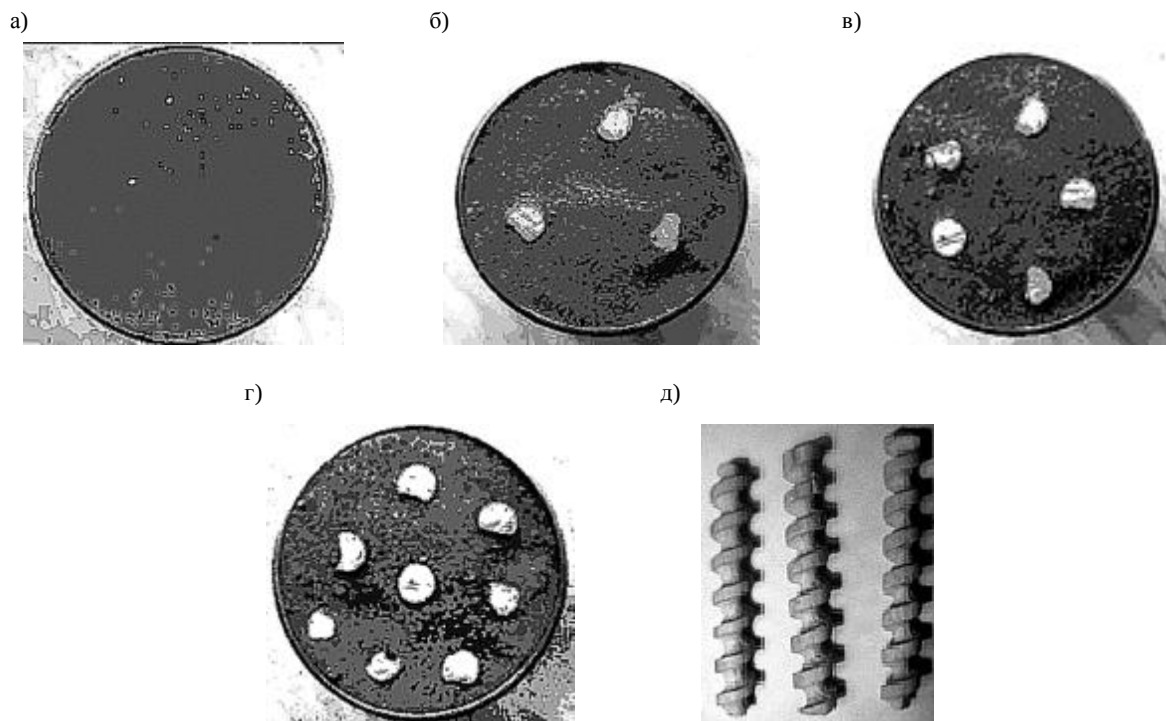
Образцы с рыхлым песком, армированным деревянными элементами-моделями. а) грунт без армирования; б) грунт армированный тремя армоэлементами-моделями; в) то же пятью; г) то же восемью
